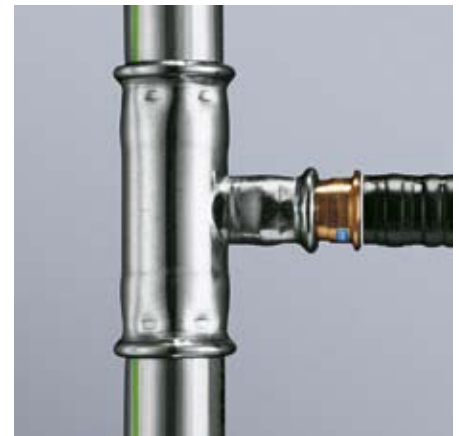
Steigstrang mit Edelstahlrohr und Stockwerksleitungen mit Metallverbundrohr.
